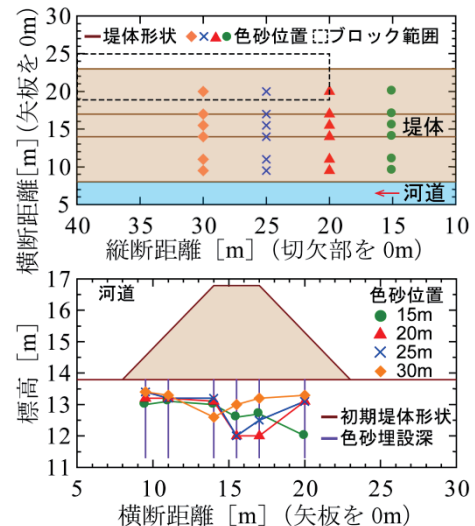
最大洗掘深の推定(上図：平面図，下図：横断面図)
